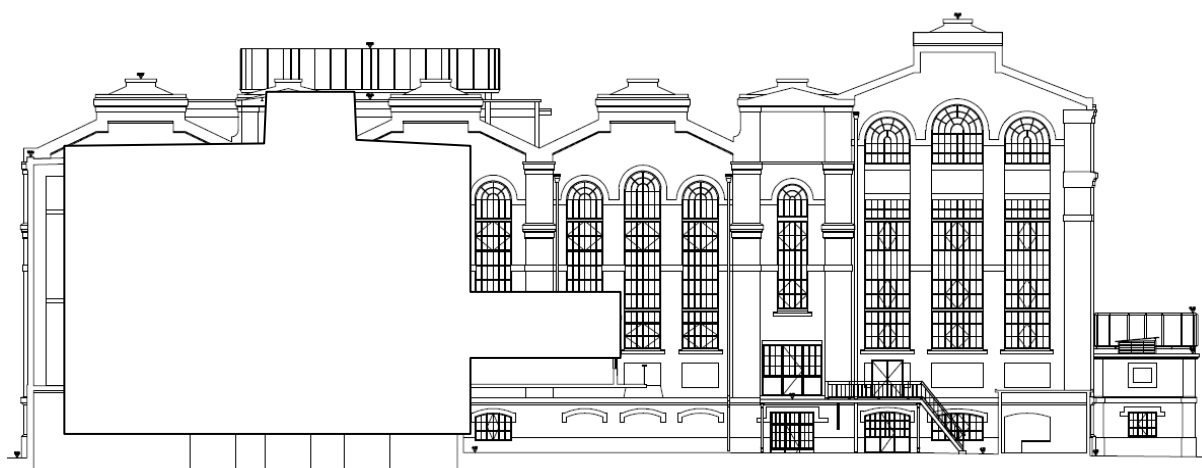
Fachada Poente do edifício da Baixa Pressão.
